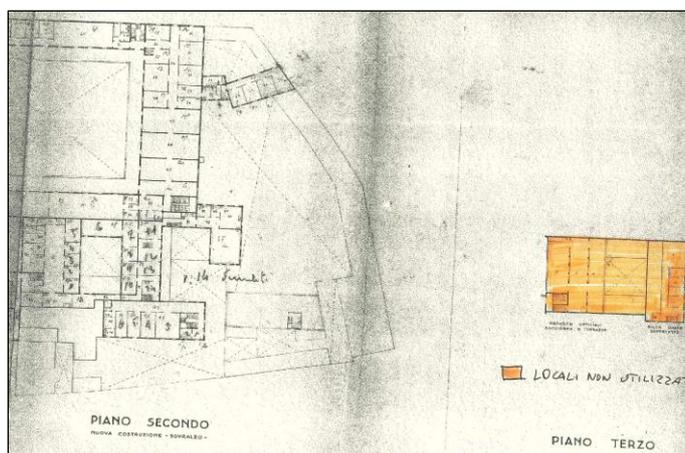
Min. Difesa - *Inventario* – Planimetria del piano terzo (1939-1944)
